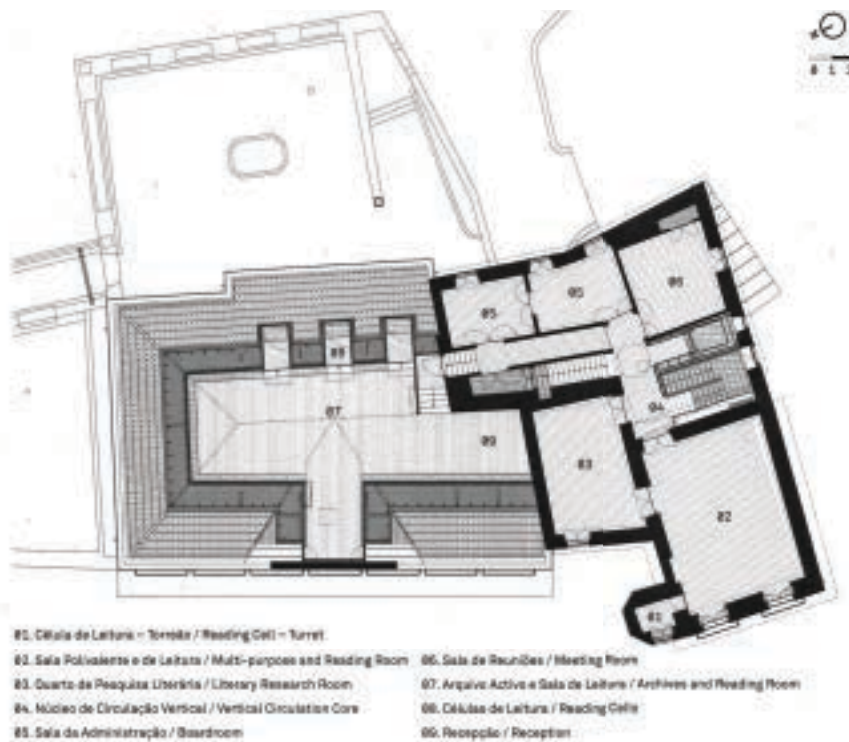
Planta do sótão. (Ribeiro, 2013a, p. 133)
